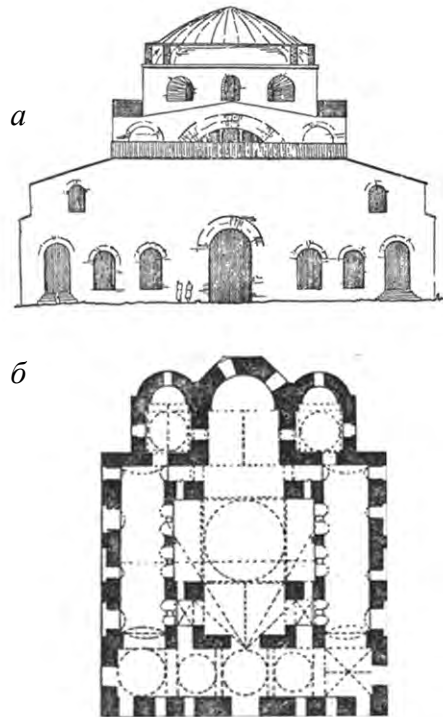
Собор Софии в Фессалониках, VIII–IX вв.: а – фасад; б – план
